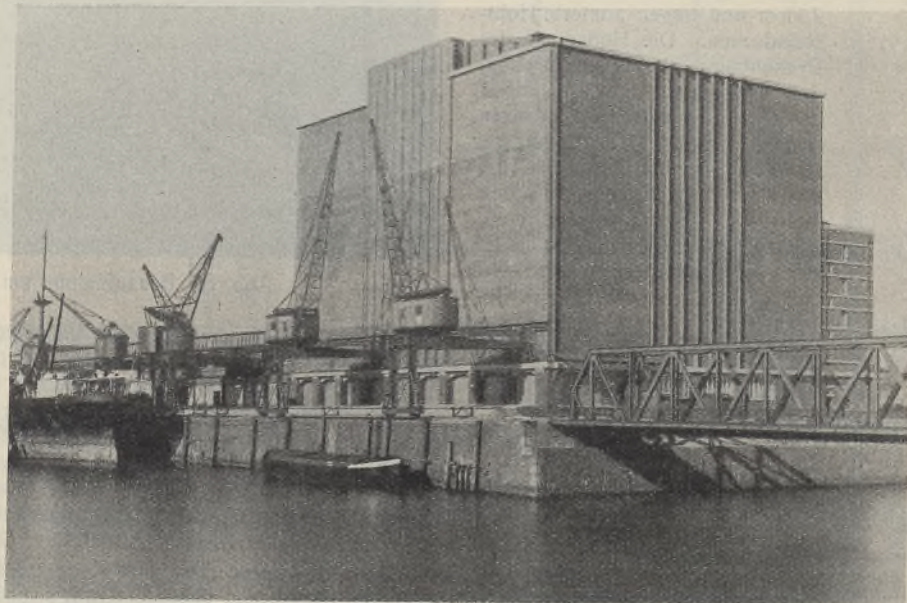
Ansicht von der Wasserseite mit Ladeanlagen.
